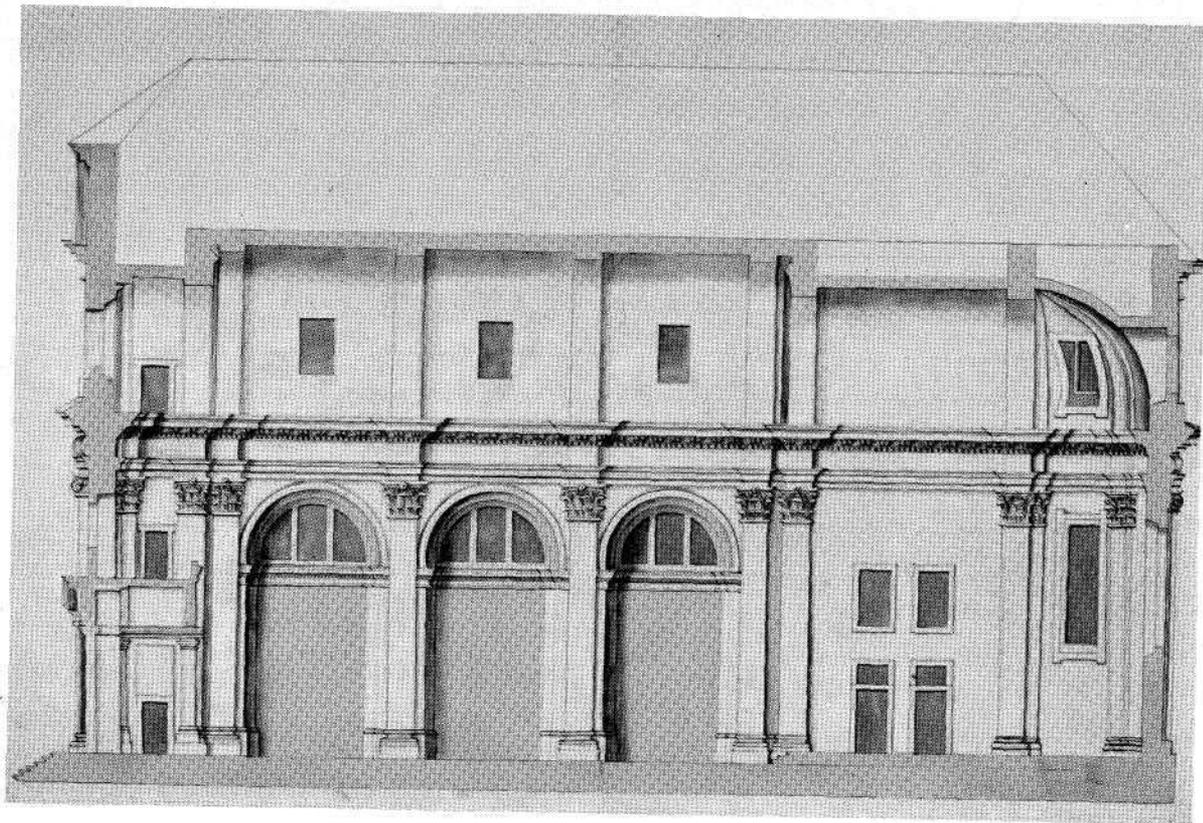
Altbunzlau, Wallfahrtskirche, Längsschnitt
